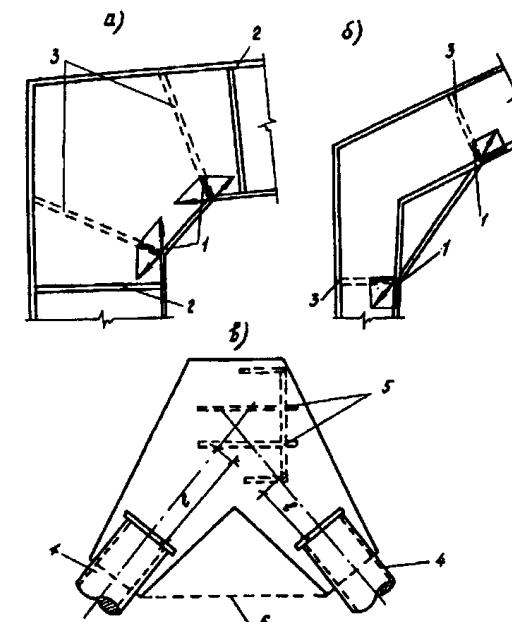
Схемы узлов примыкания элементов стальных конструкций, приведших к авариям (а — ригеля и колонны спортивного здания; б — ригеля и колонны складского здания; в — раскоса к горизонтальным верхним элементам структурного покрытия):
